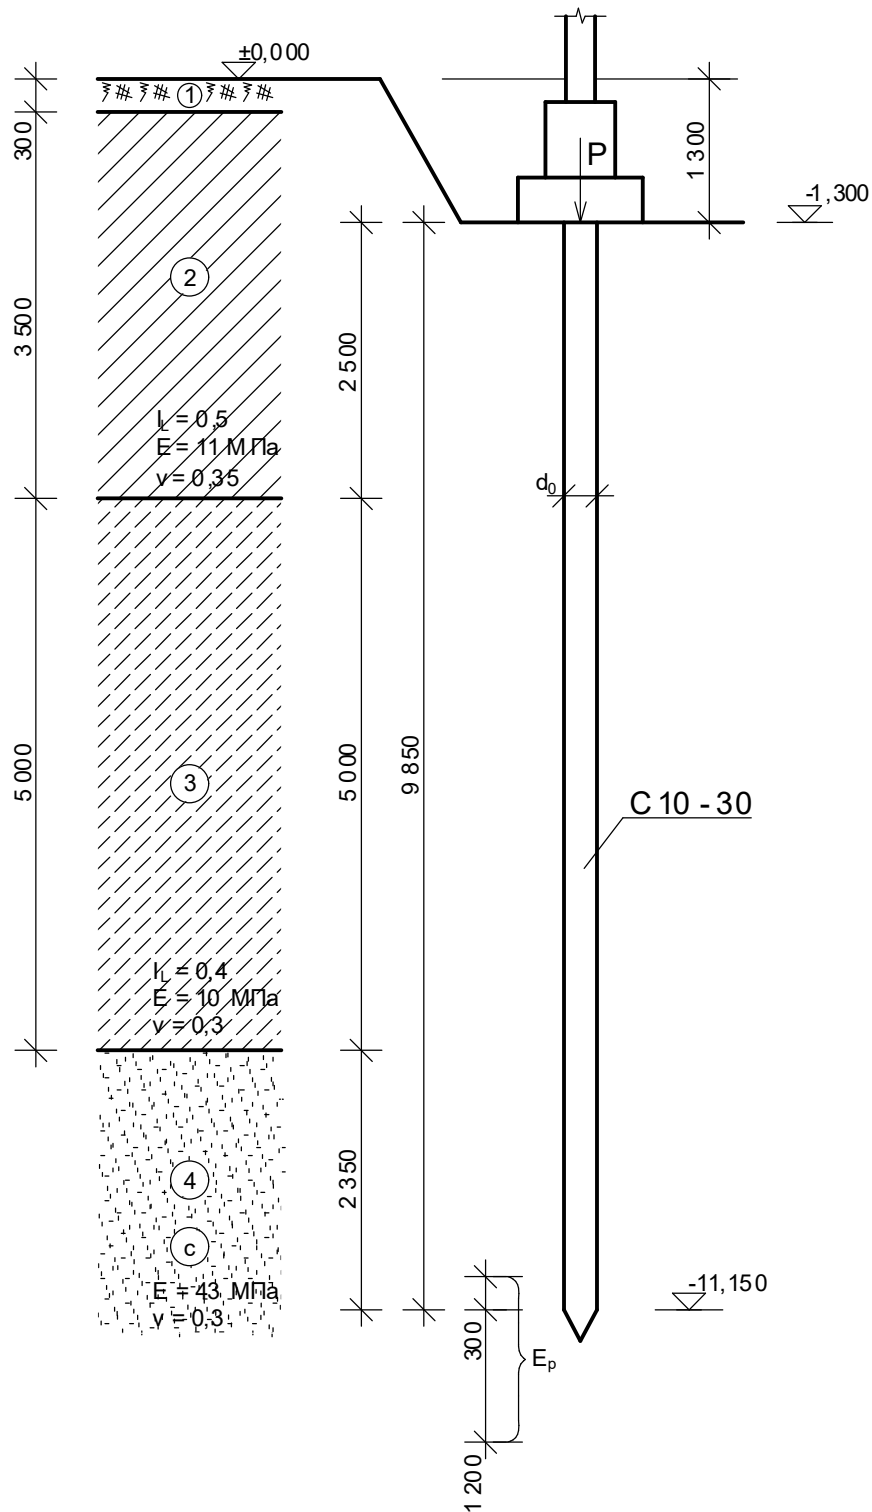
Розрахункова схема і розміщення в ґрунті пального фундаменту
